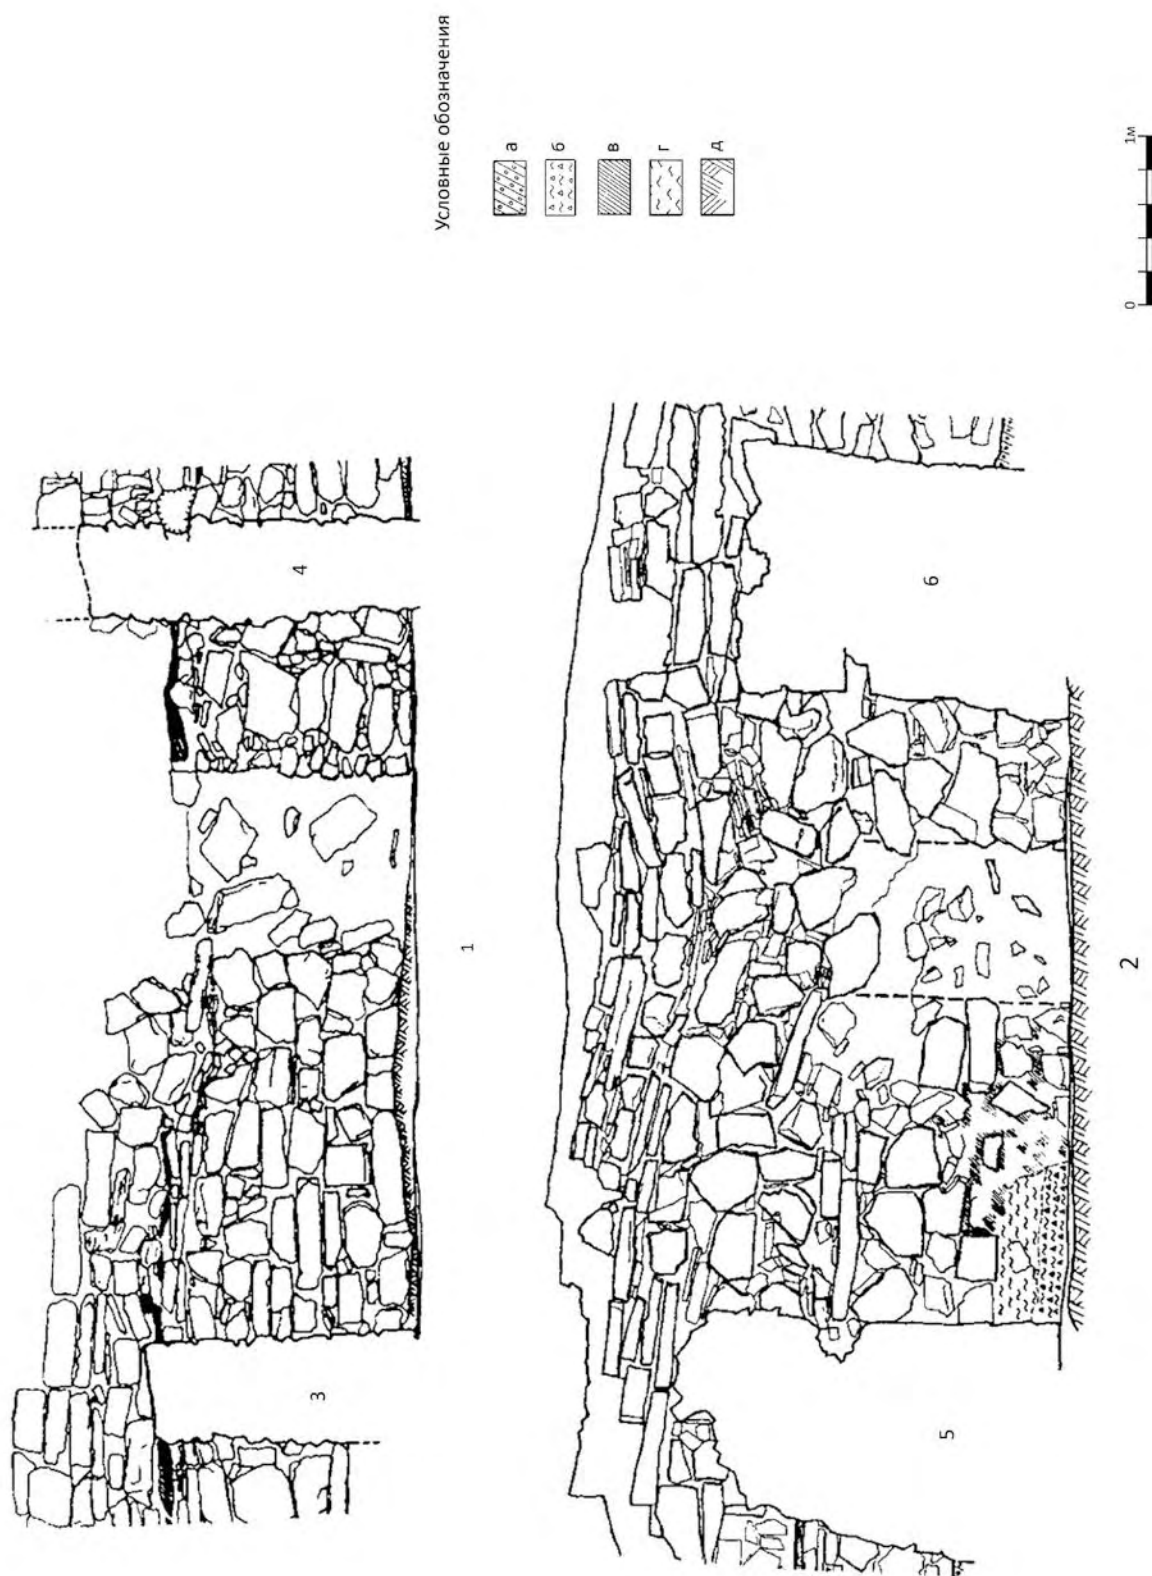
Участки внутреннего (1) и наружного (2) фасадов восточной оборонительной стены Кутлакской крепости в месте примыкания юго-восточной башни (№ 4). 3-4 – разрезы северной и южной кладок помещения 3 дома № 2; 5-6 – разрезы южной и северной фланговых стен башни № 4; а – каменно-сланцевый завал с коричневой глиной; б – зола с углями, фрагментами керамики и печины; в – фрагменты штукатурки из коричневой глины; г – пепел; д – материковая сланцевая скала.
